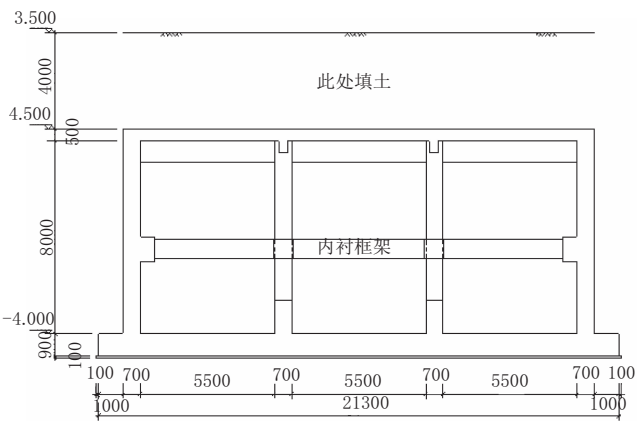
调蓄池典型横断面图 (标高单位:m,尺寸单位:mm)
